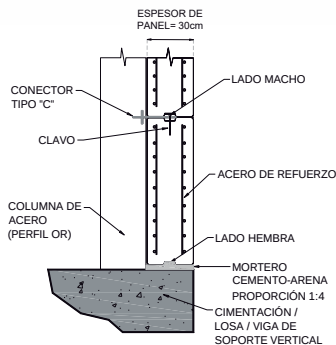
Sección de panel de concreto celular. Elaboración propia.
